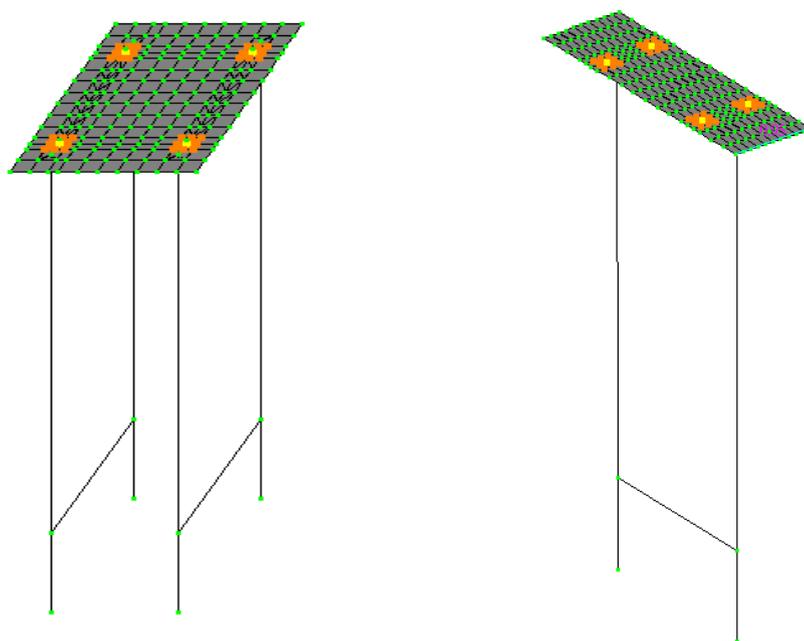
Схема дискретизации железобетонных опор пролетного строения на КЭ
